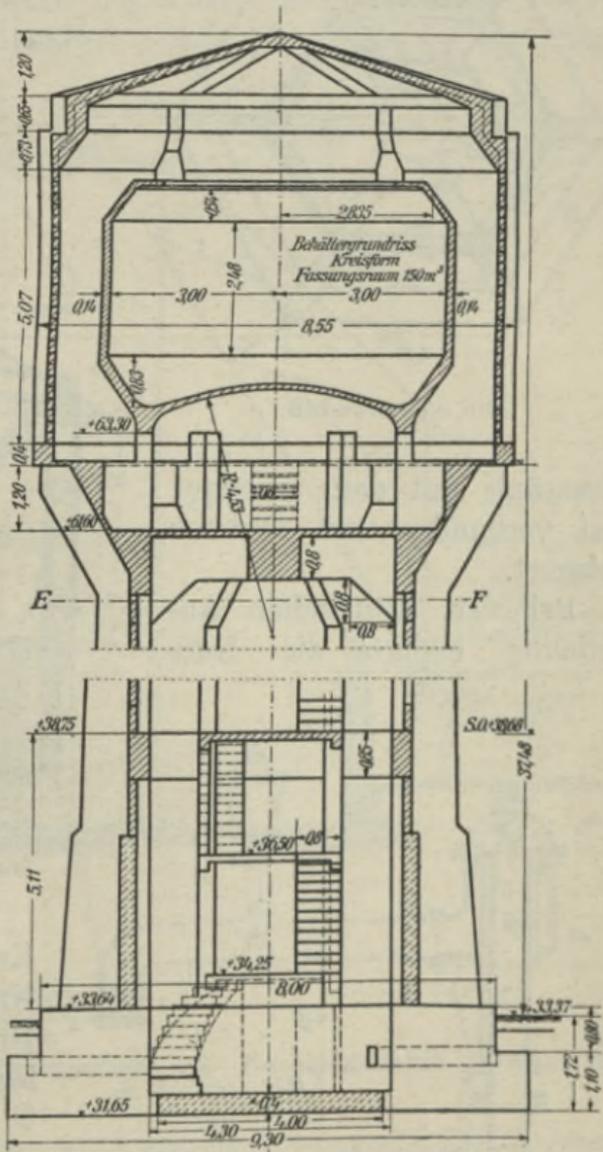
u. 83. Wasserbehälter für 300 m³ auf Bahnhof Henningsdorf in Eisenbeton. M. 1 : 200.
